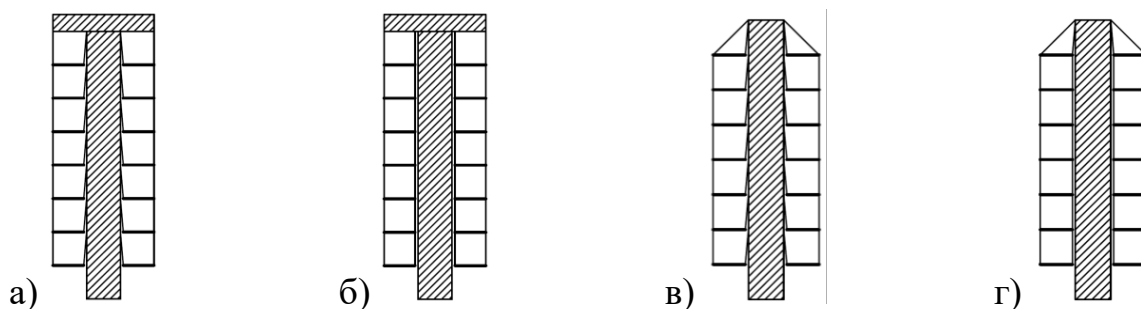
Здания ствольно-подвесной конструктивной системы с передачей нагрузки от перекрытий на: а) ствол и консольный оголовок здания; б) на консольный оголовок здания; в), г) на ствол здания
